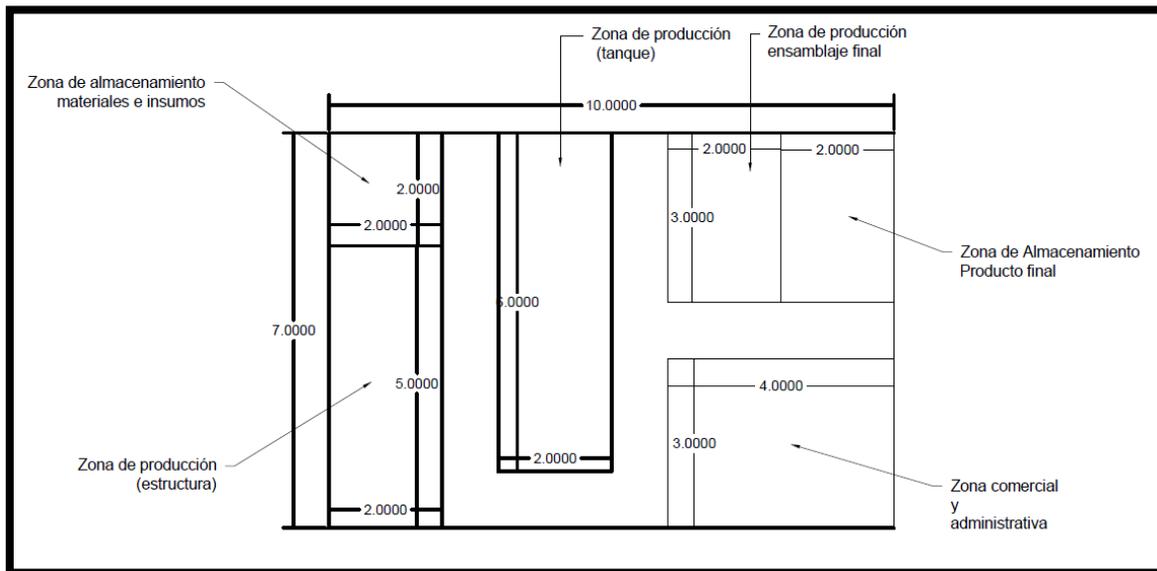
Distribución planta, empresa Ekomuro H2O +. Fuente: Autor ,2017
